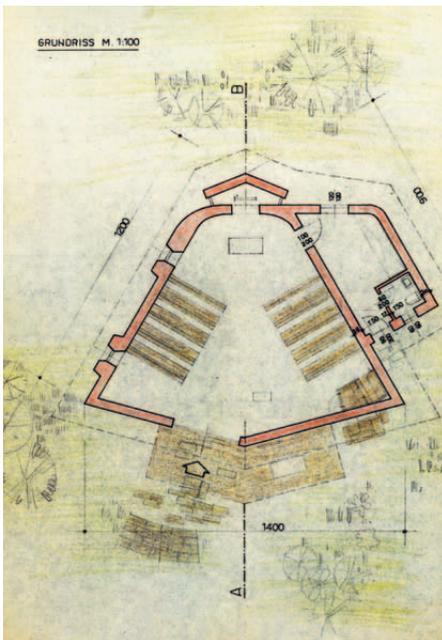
Der Grundriss der Mendelkirche¹⁰
